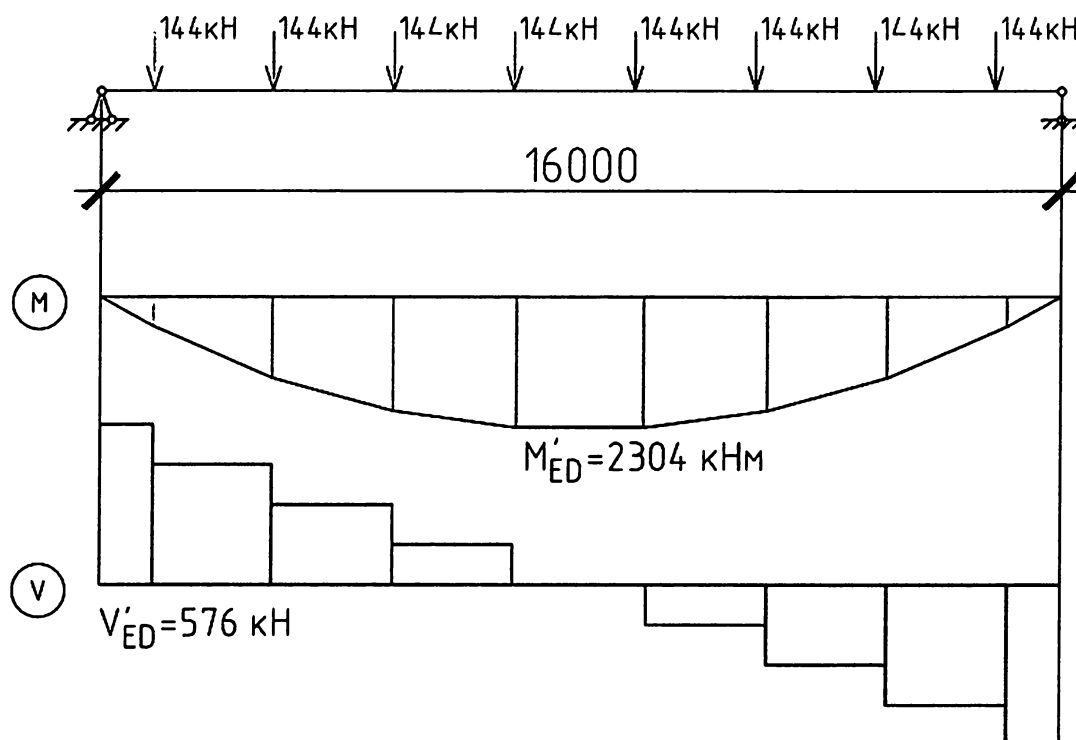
Расчетная схема балки и эпюра внутренних усилий
